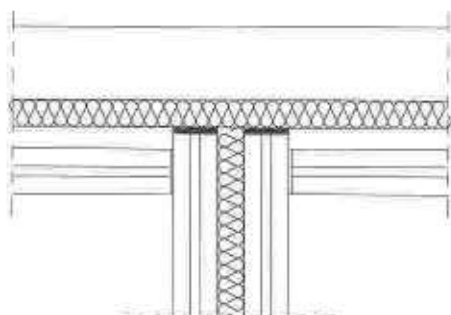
Encuentro desolidarizado de ESV-2 y fachada con aislamiento rígido
